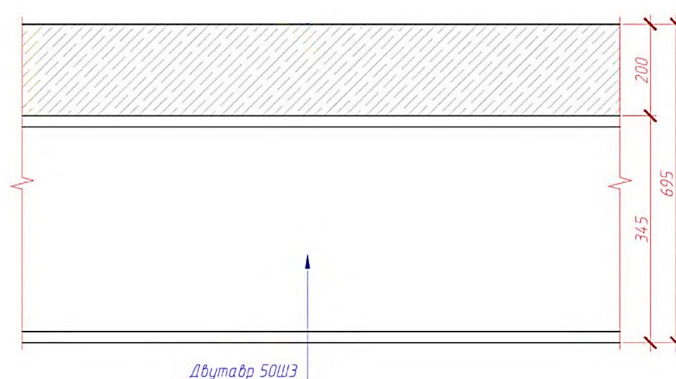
Перерізи сталезалізобетонного перекриття
